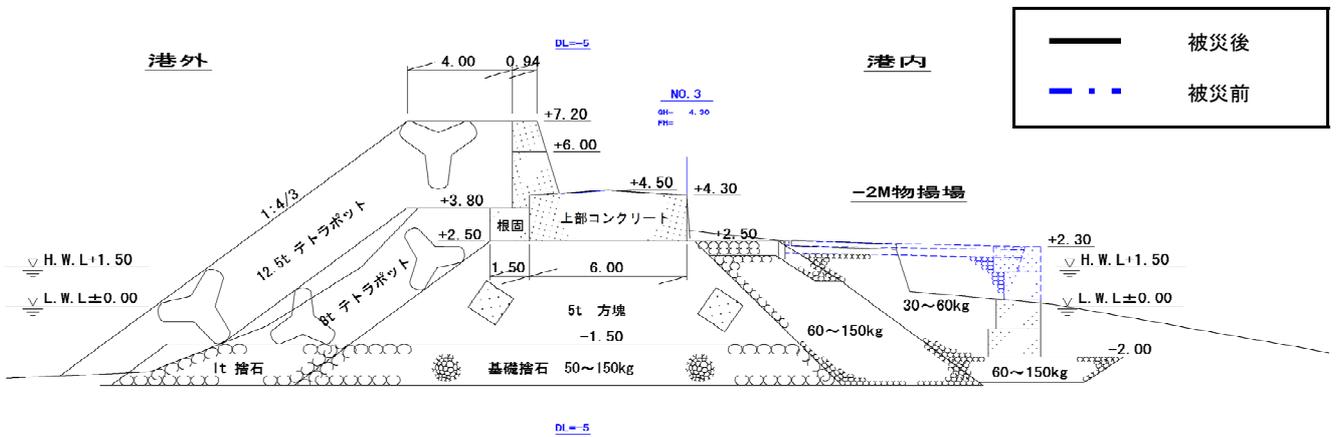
No.25 大洗港区_第1埠頭地区B物揚場 (-2m) の断面図 (被災後)
